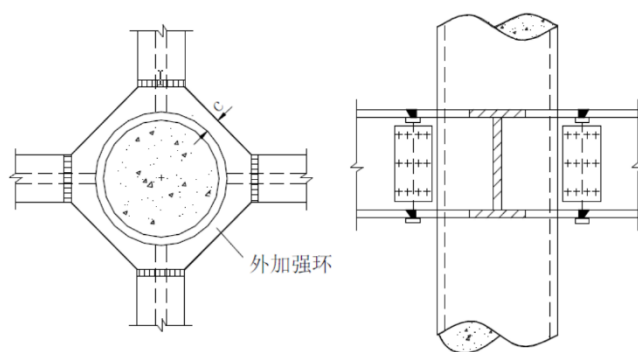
钢梁与钢管混凝土柱刚性连接示意图
